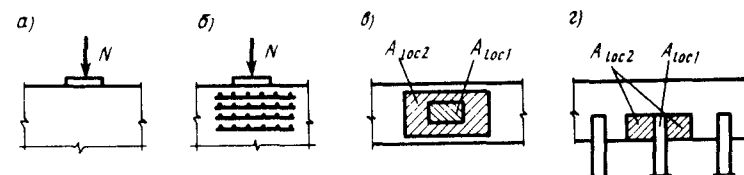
К расчету железобетонных элементов на местное сжатие
